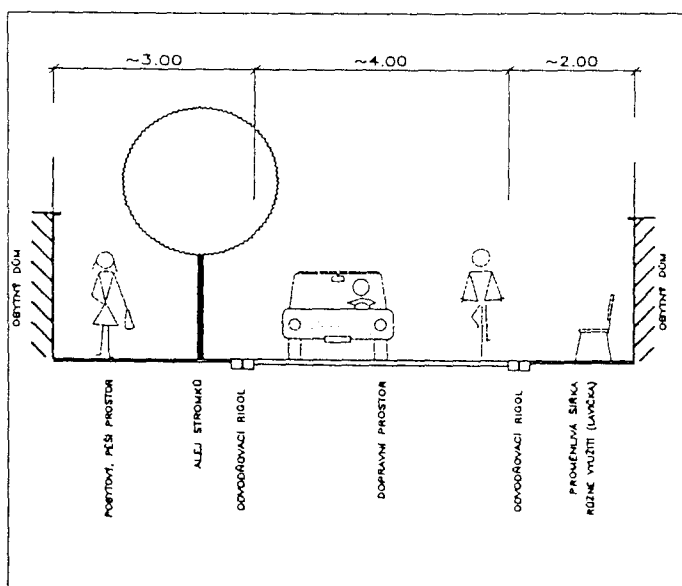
Příklad geometrického řešení uličního prostoru obytné ulice nepravidelného tvaru (srovnej též s obr. 4 a 44)
